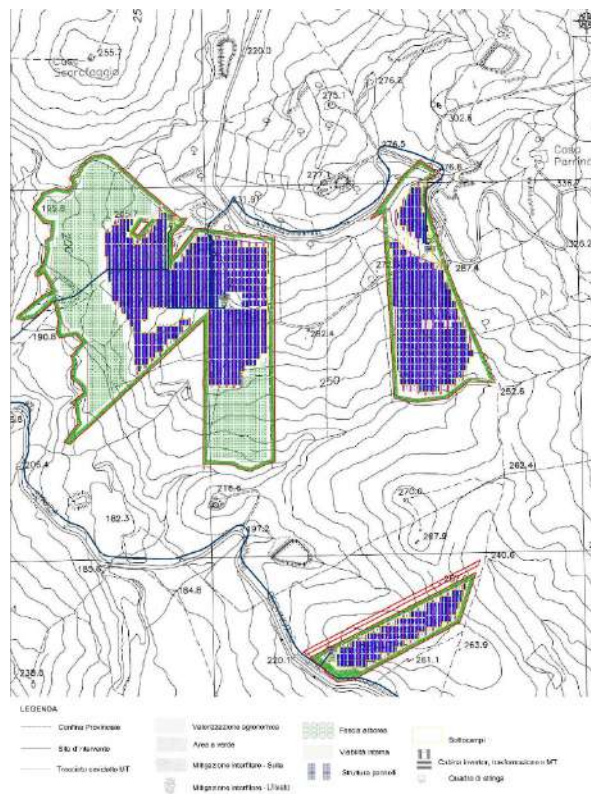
B – Layout dell'impianto ricadente in Contrada Parrino con cavidotto
